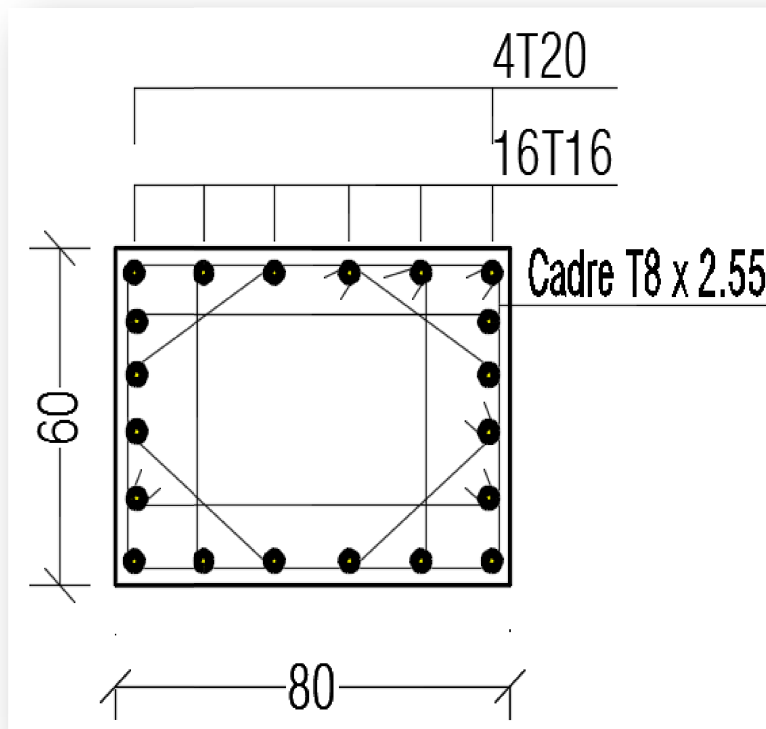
Ferraillage du poteau rectangulaire 80x60
